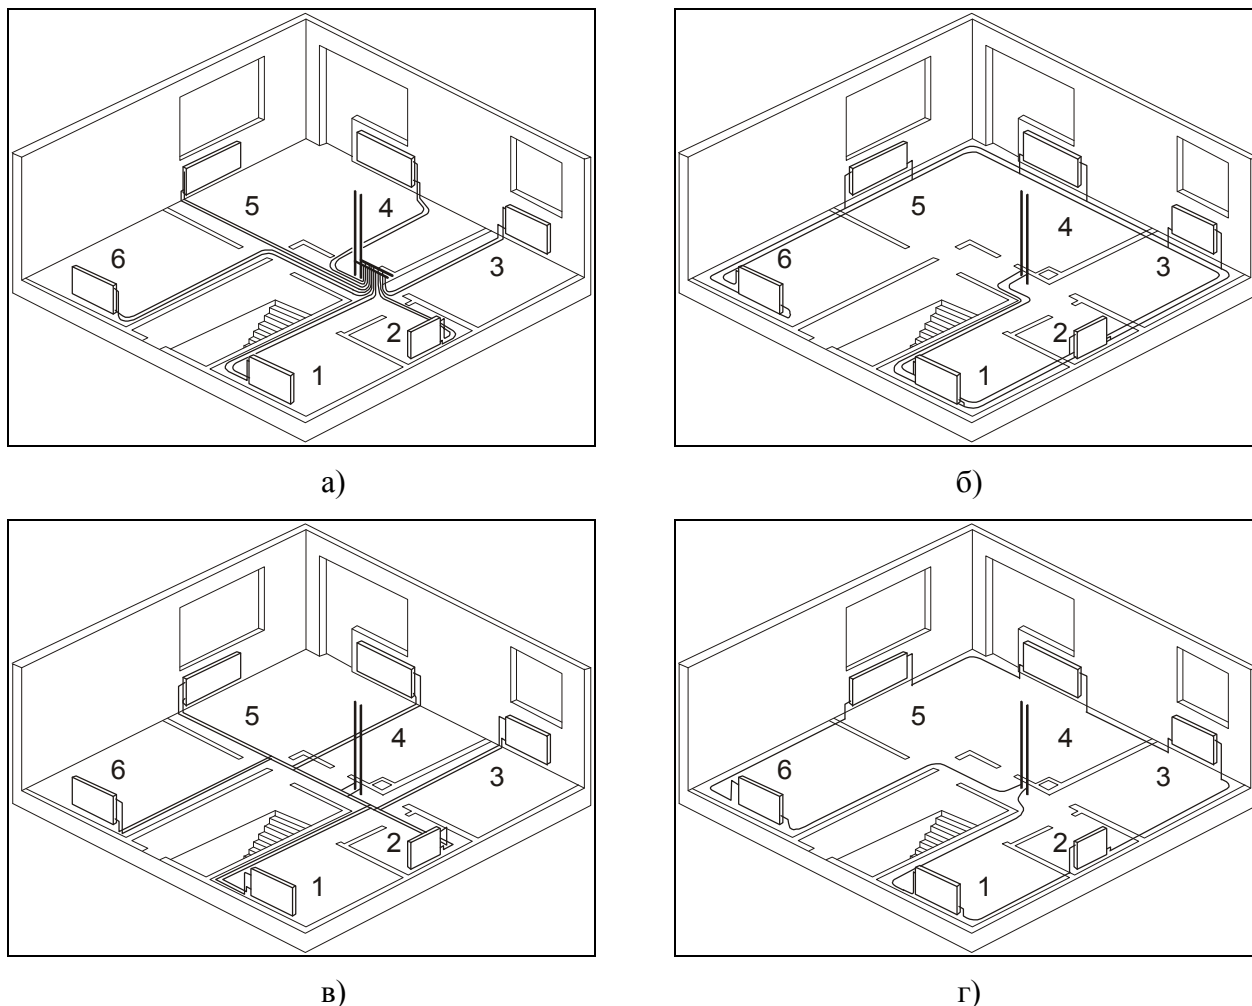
Схемы прокладки трубопроводов систем поквартирного отопления
